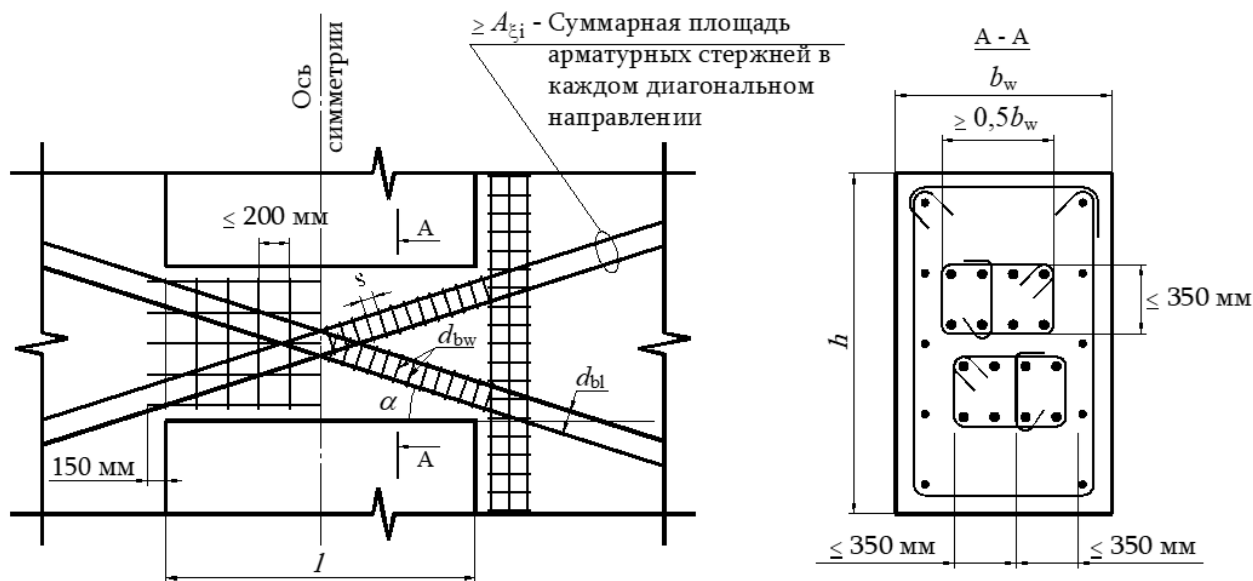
Связующие балки с диагональным армированием по пункту 5.9.4
